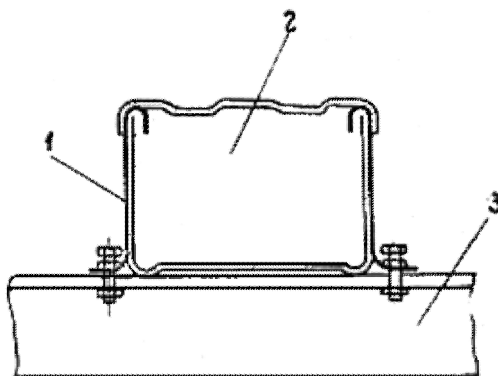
Крепление коробов к конструкциям: 1 - скоба У1078, У1059; 2 - короб; 3 - конструкция
